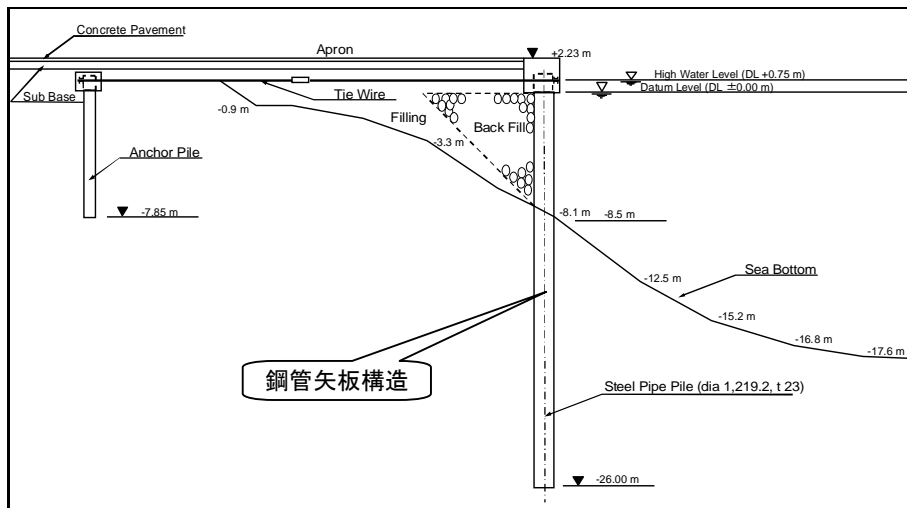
ホニアラ港国際埠頭岸壁の標準断面図
